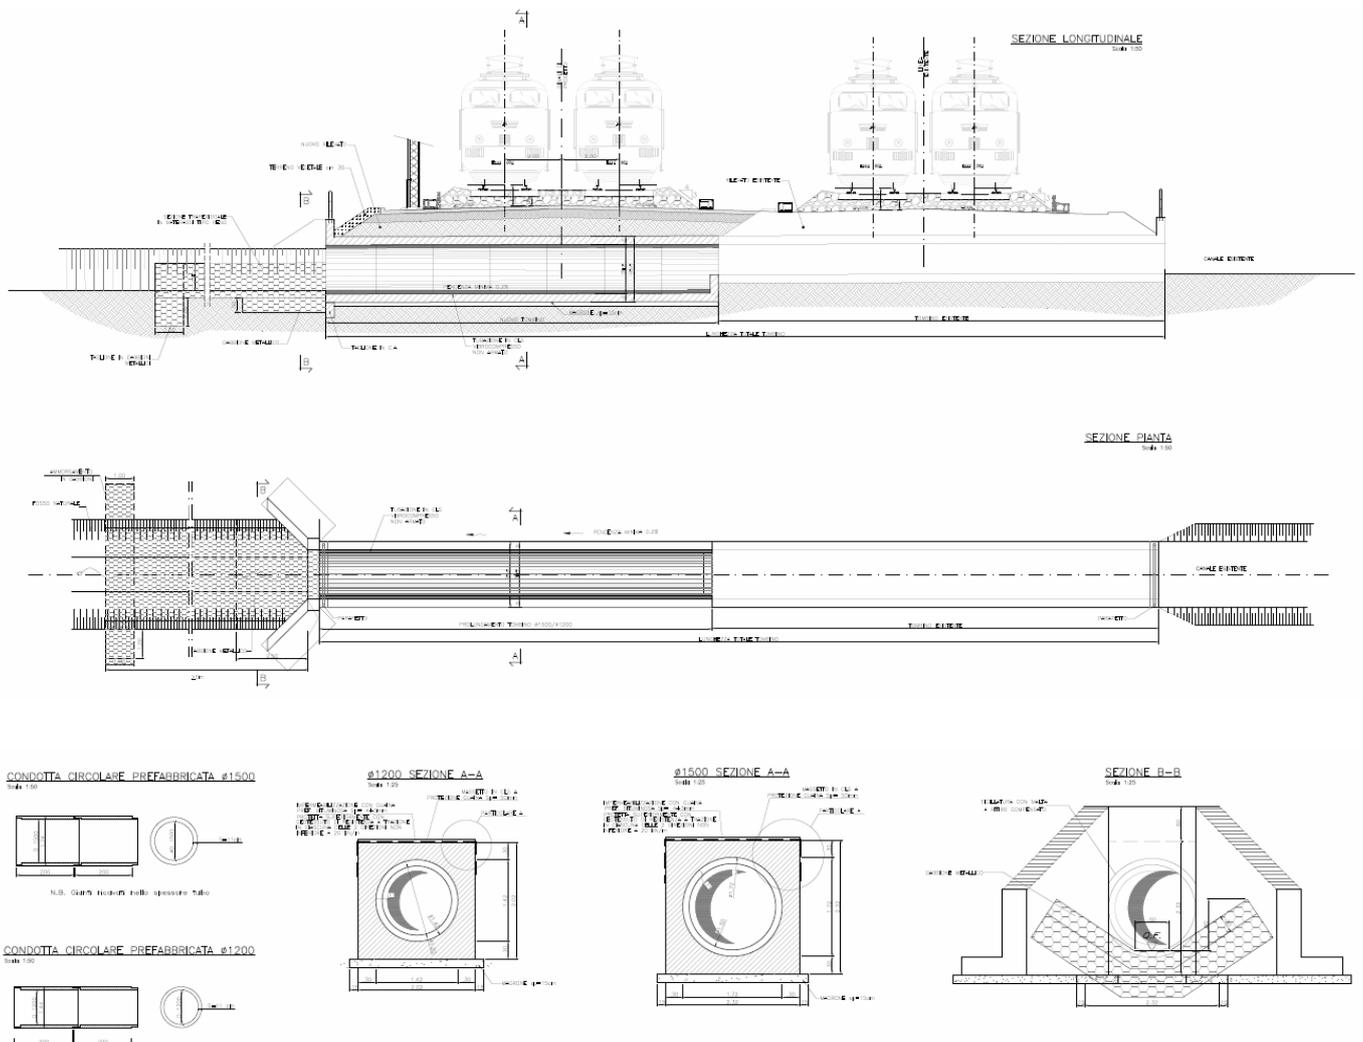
Sezione longitudinale e sezione pianta tombino circolare
